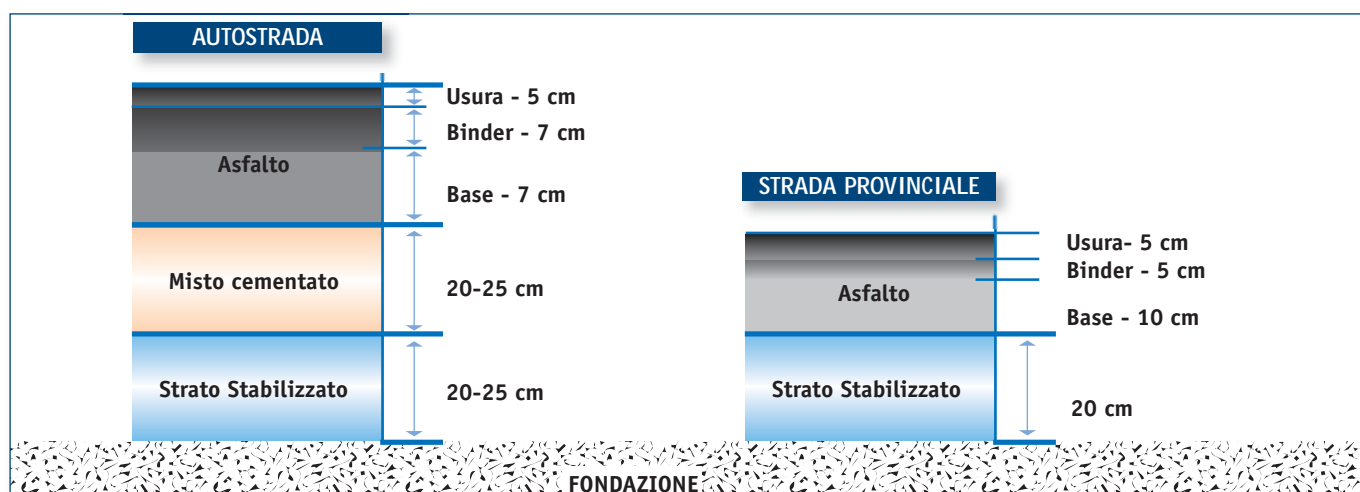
Sezione tipo della sovrastruttura per autostrade e altre strade
